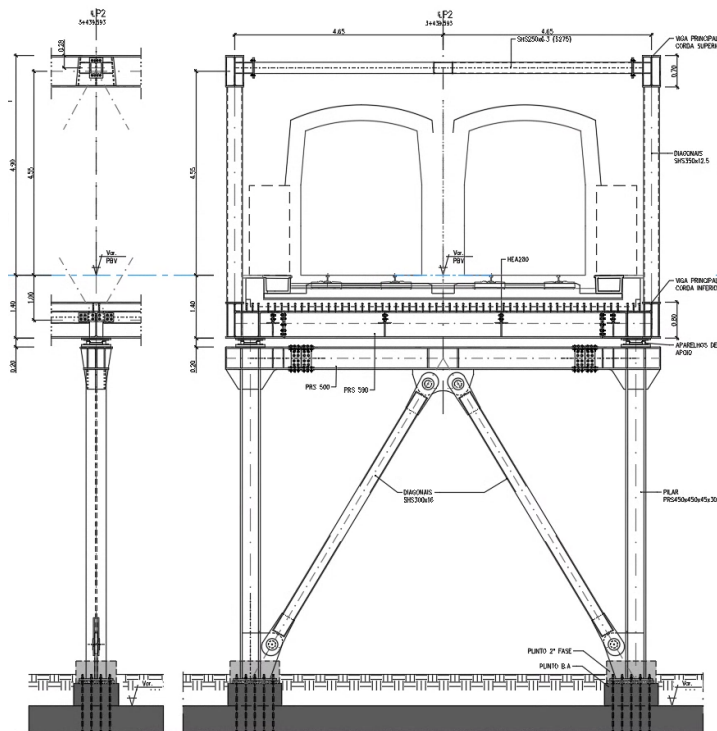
Secção transversal e longitudinal P2, P3 e P4.
